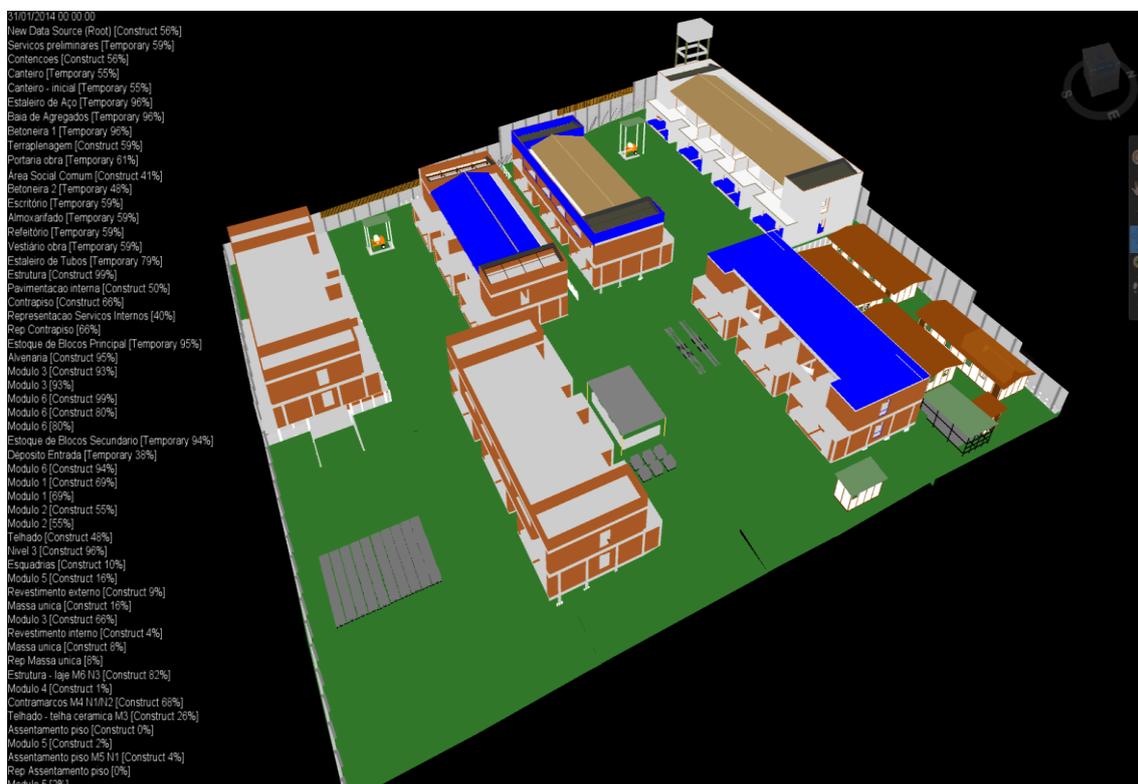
Planejado em 31/01/14: estrutura, telhados, revestimentos e canteiro
